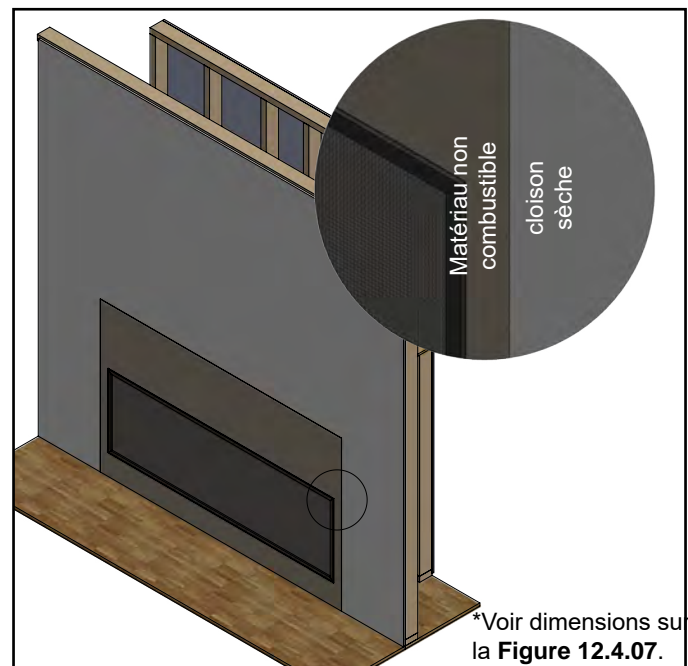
Carrelage sur la façade du foyer et des cloisons sèches
